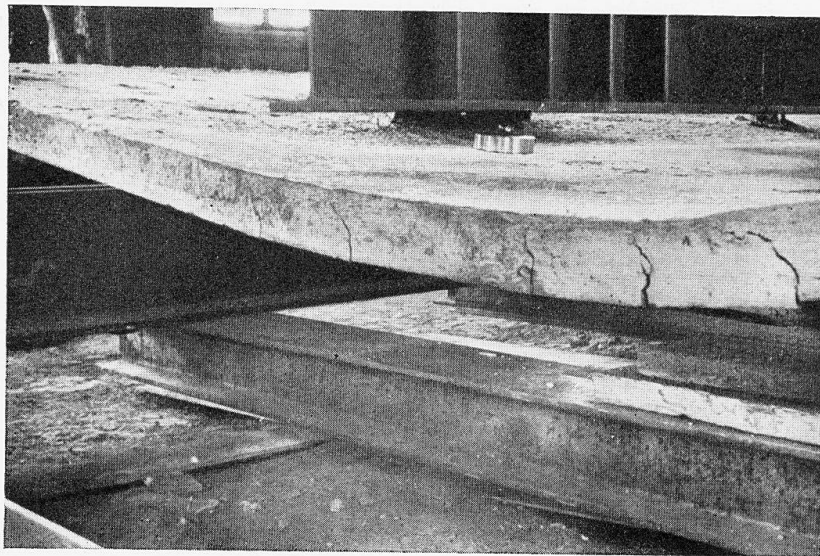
Fissures de traction sur les bords de la dalle (à la rupture).
